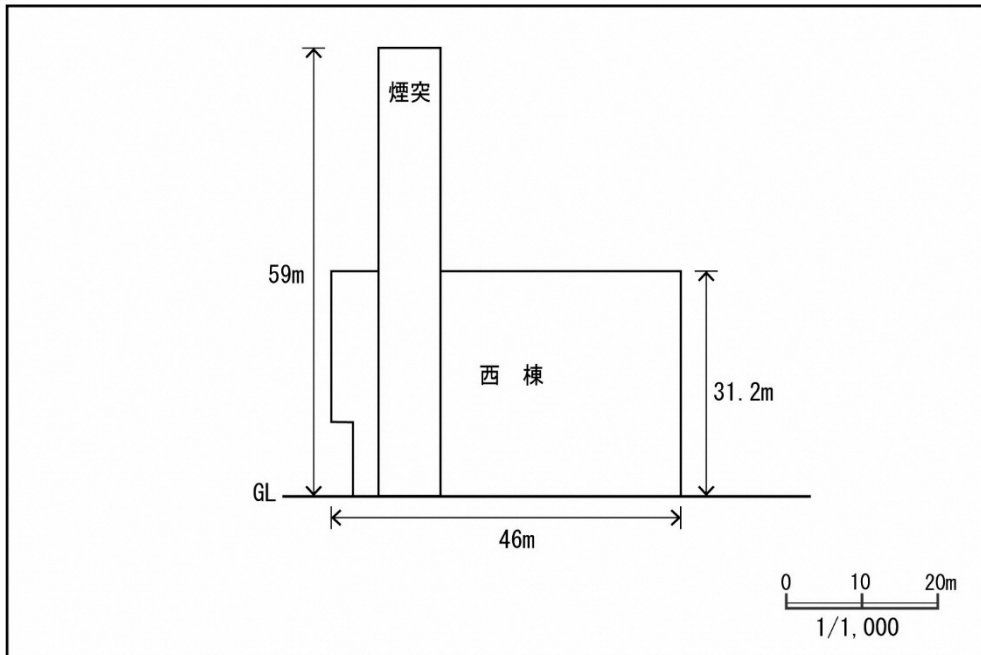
(1) 日影の予測に用いた施設の形状 (平面図)
